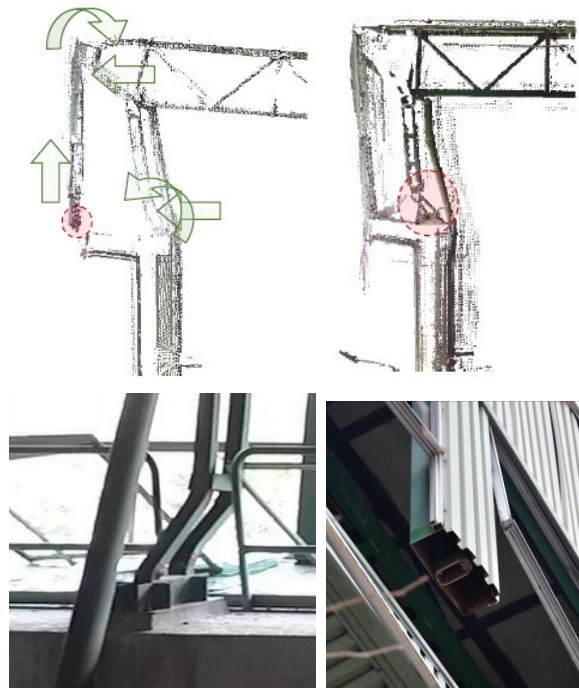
Detalle de las distorsiones ocurridas en pilares perimetrales .
